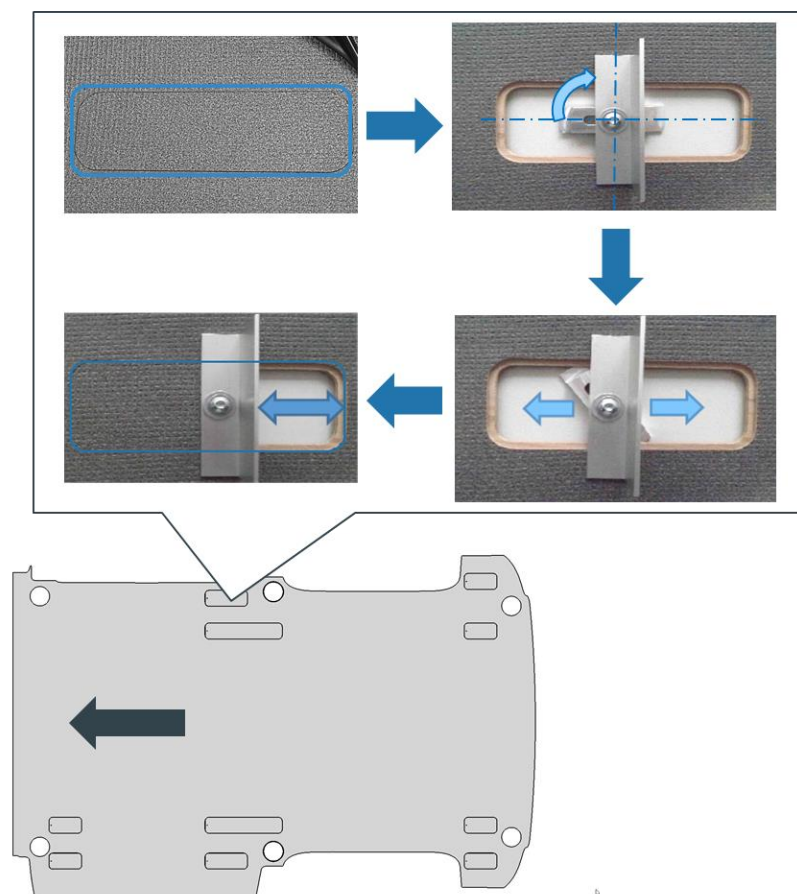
Универсальный пол (5BM) – места крепления для шкафов и стеллажей (показан Transporter, короткая база со сдвижной дверью справа)
